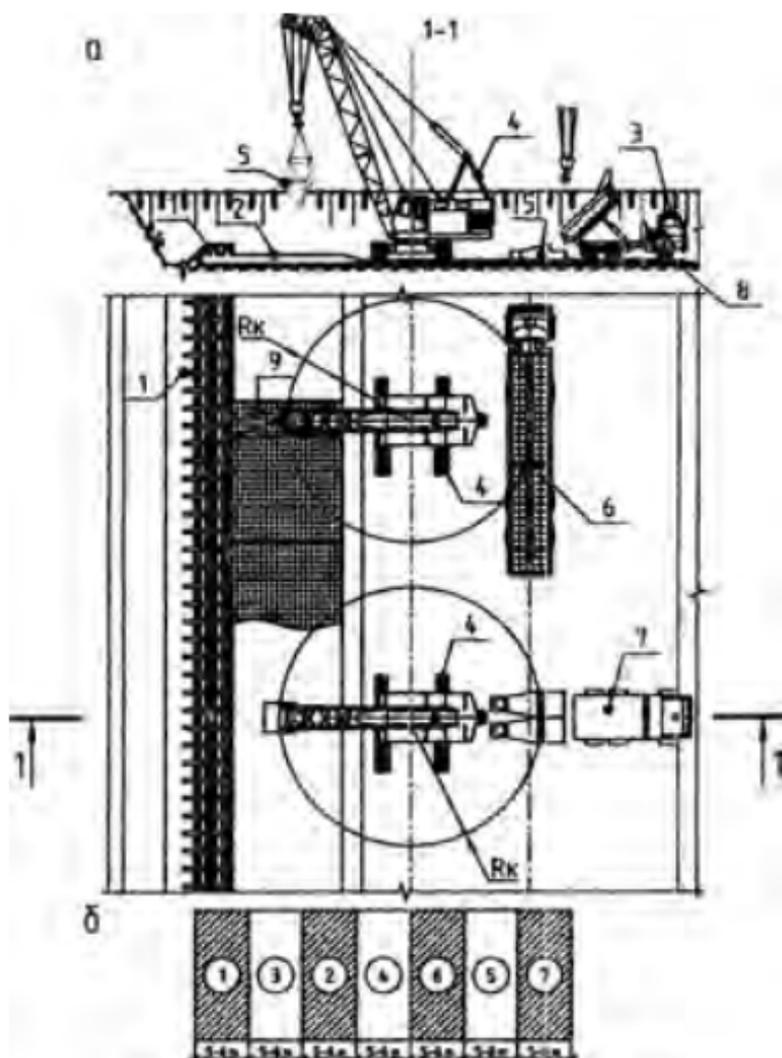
Схема организации работ при бетонировании днища прямоугольного сооружения.
